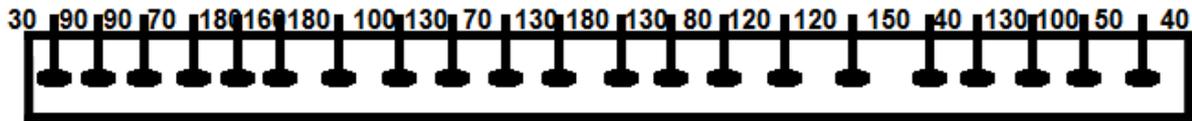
Perfil “U” superior – Vista inferior – fixação na alvenaria
